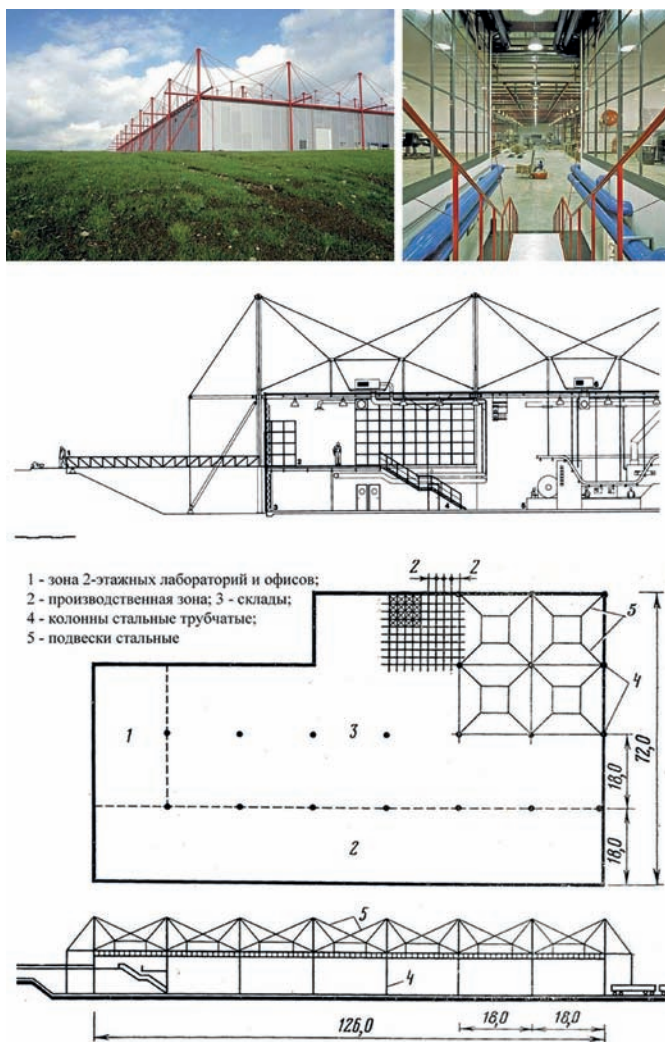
Научно-производственный комплекс Флитгард, Кимпер: фрагмент общего вида здания, интерьер рабочего помещения, схемы плана и продольного разреза
